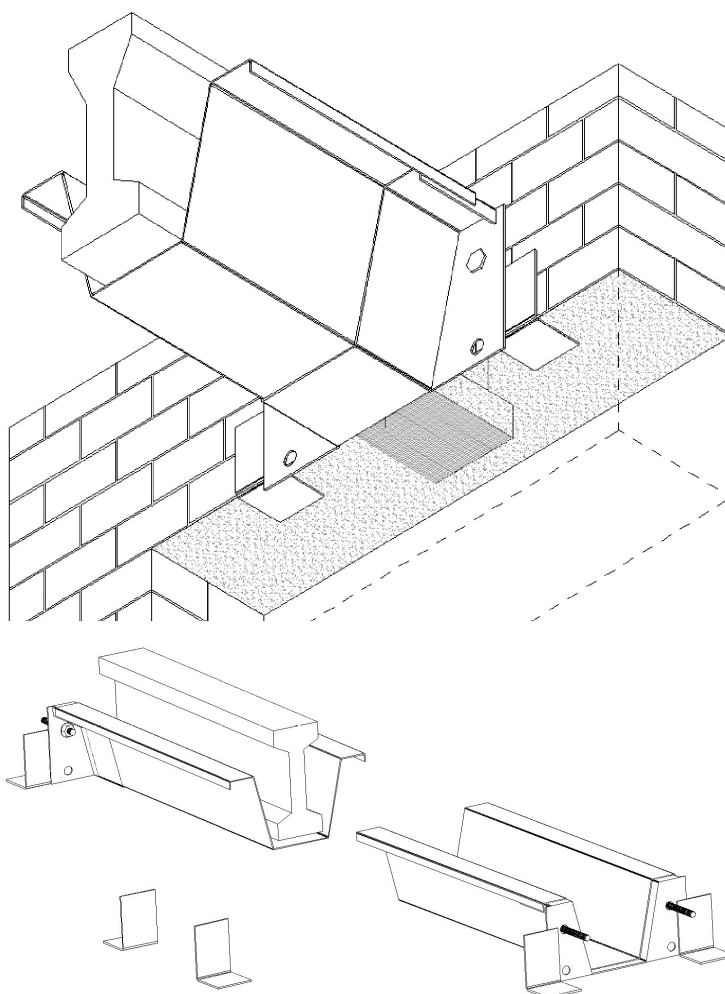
APOYO SOBRE MURO DE FÁBRICA.
